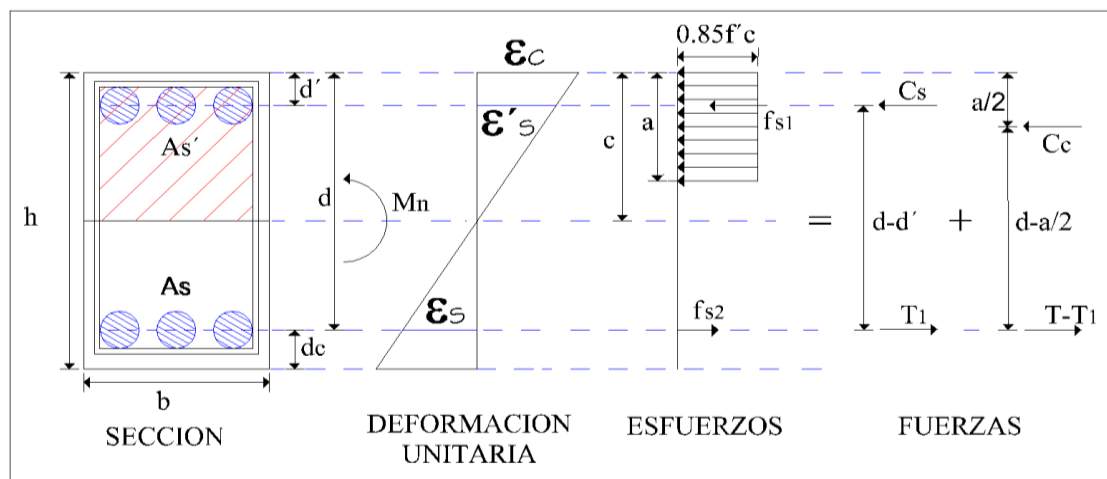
Sección rectangular de concreto doblemente reforzada (Fuente: Figura 3.11. “Diseño de Estructuras de Concreto”. Arthur N.)
